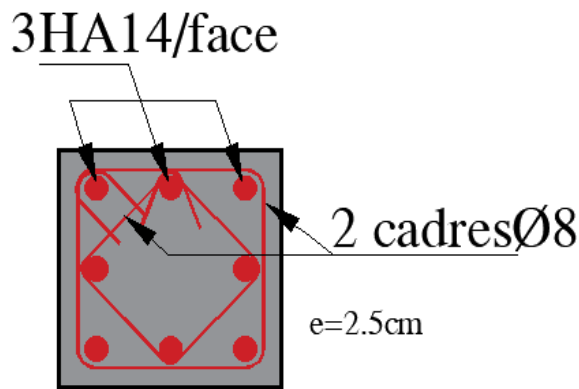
Schéma de ferrailage des poteaux du (4ème étages et la buanderie)
